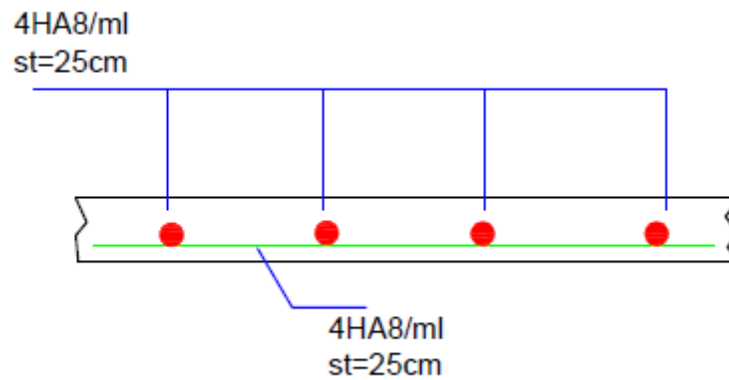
Schéma de ferrailage de la dalle cas charge concentrée
